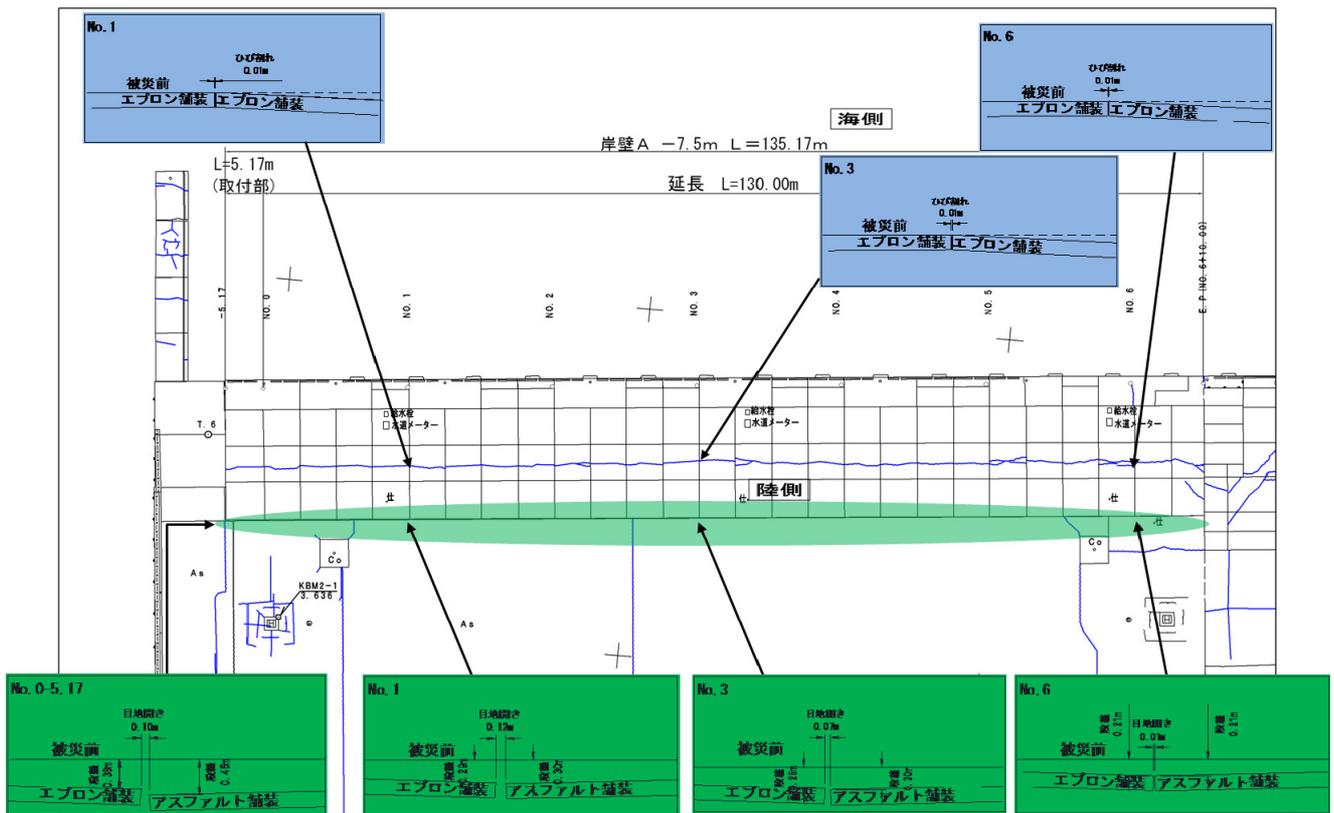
No.20 常陸那珂港区_中央ふ頭地区岸壁 (-7.5m) の平面図 (被災後)
